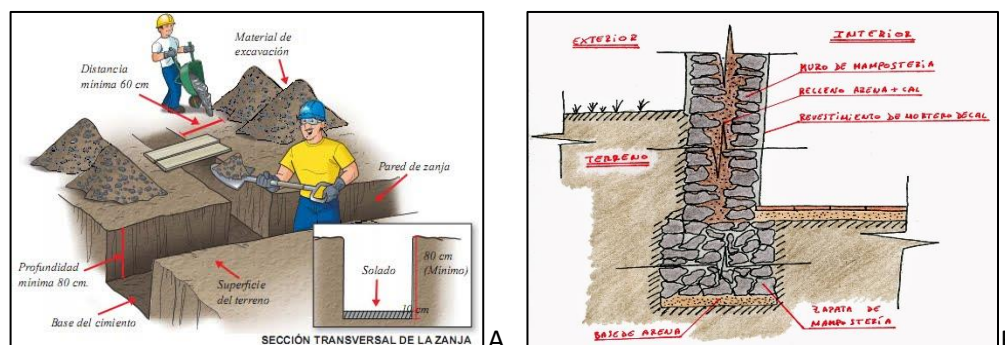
Partes de la cimentación superficial. A) Excavación de zanja y B) Cimiento de mampostería.
